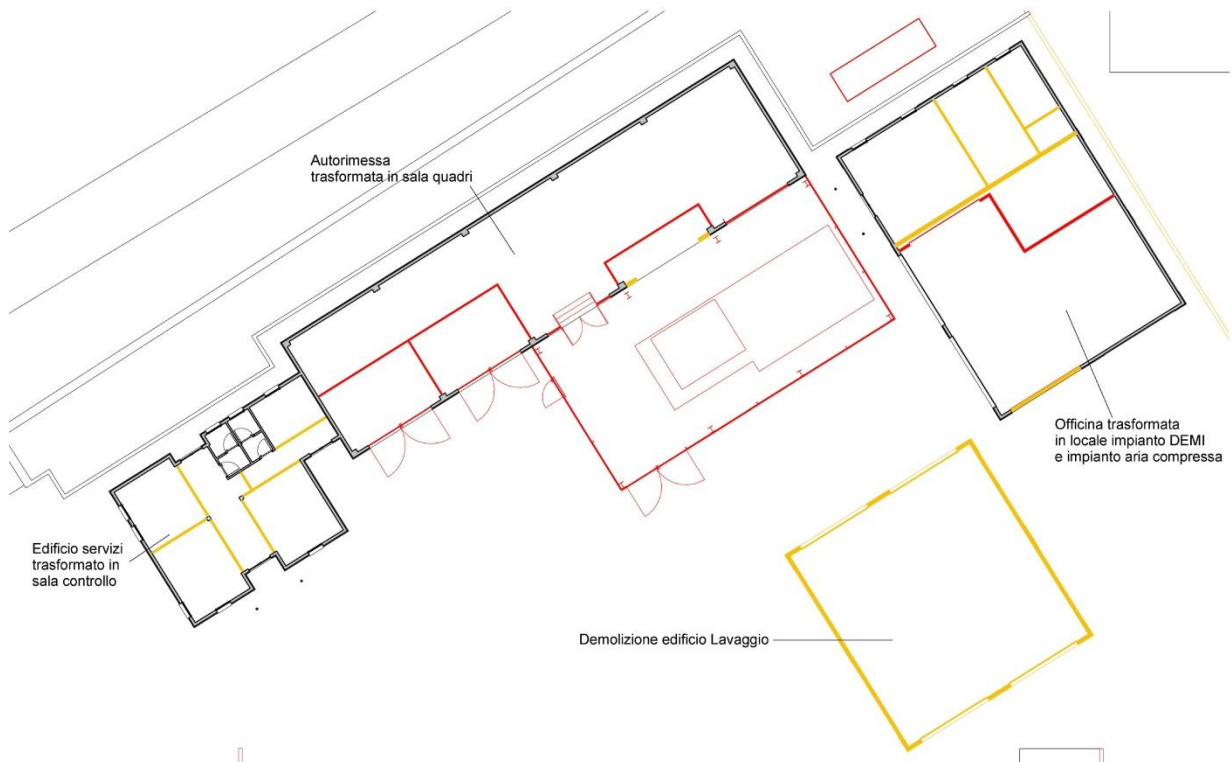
Planimetria con i principali interventi di demolizione e recupero degli edifici esistenti
